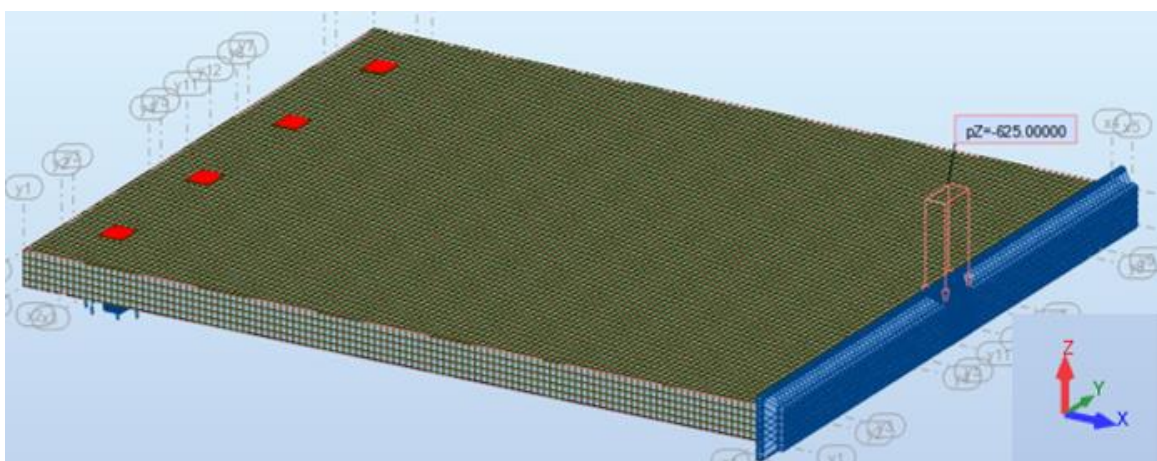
Modelo de elementos sólidos: malha regular de 0,625 cm em planta nos A+C e malha de Delaunay de 6,25 cm em planta em L, para carga na Posição 3 (Robot)
